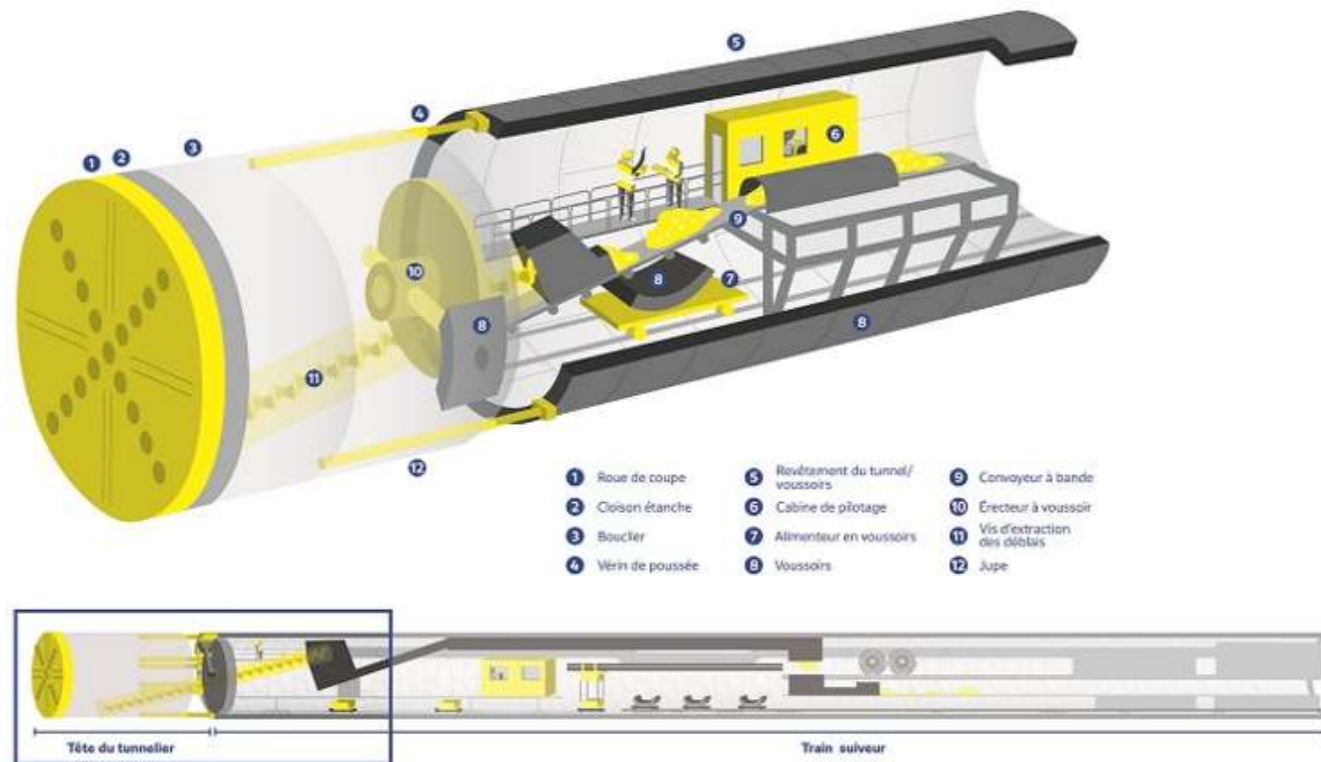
Schéma du fonctionnement d'un tunnelier (Source : SGP)
